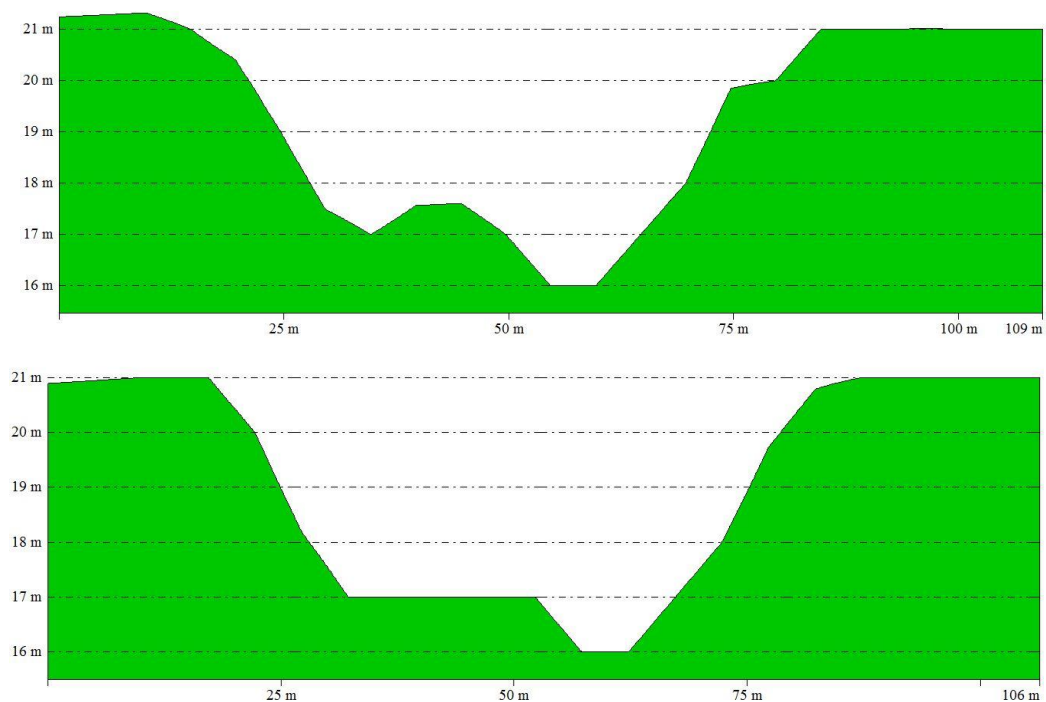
Perfil transversal Puente n°3.1 y 3.2 (Puente de doble tablero)
